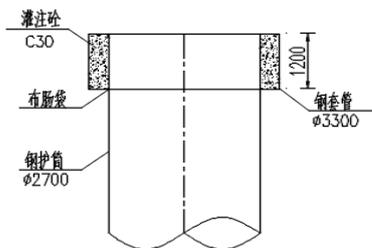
砂浆肠袋+灌注混凝土封堵示意图(单位: mm)
